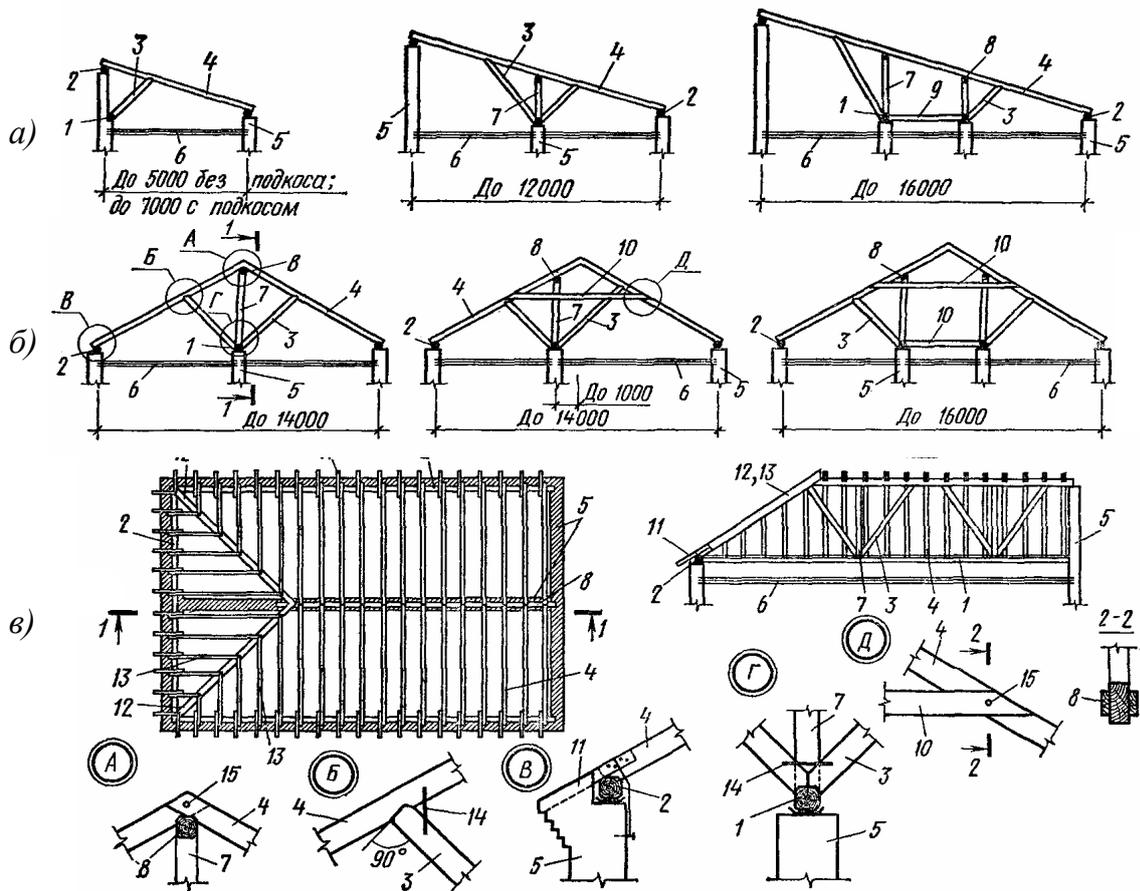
Наклонные стропила: а – односкатных крыш; б – то же, двускатных; в – план стропил; 1 – лежень; 2 – мауэрлат; 3 – подкос; 4 – стропильная нога; 5 – стена; 6 – чердачное перекрытие; 7 – стойка; 8 – прогон; 9 – распорка; 10 – схватка; 11 – кобылка; 12 – накосная (диагональная) стропильная нога; 13 – нарожник; 14 – скоба; 15 – болт
